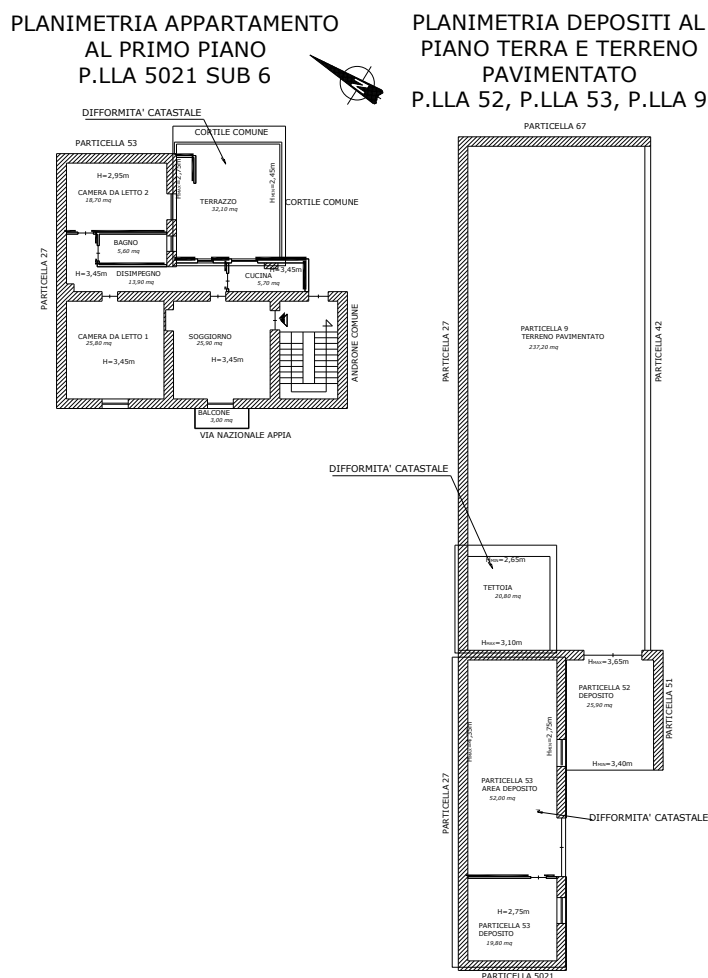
planimetrie delle difformità catastali dell'appartamento al primo piano – p.lla 5021 sub 4; del deposito pertinentziale al piano terra – p.lla 53; della tettoia presente sul terreno – p.lla 9
